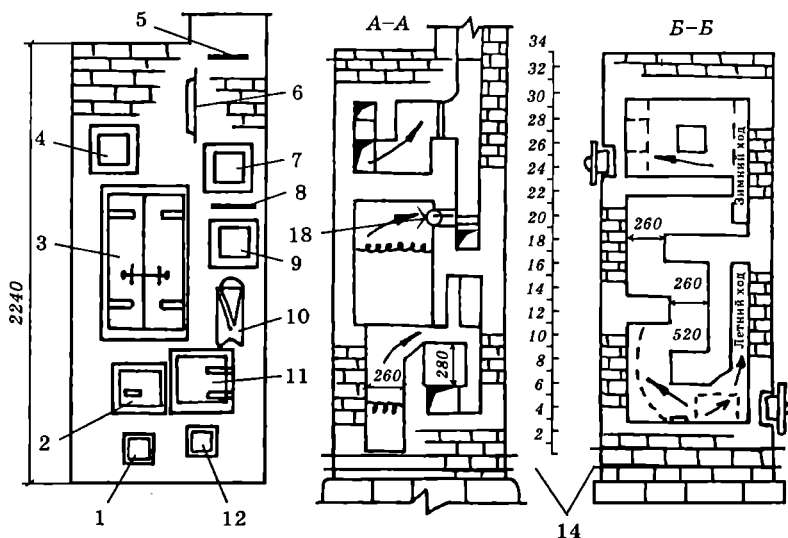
Отопительно-варочная печь конструкции И. Ф. Волкова: 1 — поддувало; 2 — топка; 3 — варочная камера; 4 — чистка; 5 — дымовая задвижка; 6 — задвижка, открываемая зимой; 7 — самоварник; 8 — задвижка, открываемая летом; 9 — чистка; 10 — водогрейная коробка; 11 — духовка; 12 — чистка; 13 — металлическая сетка в рамке; 14 — гидроизоляция; 15 — замкнутая внутренняя камера; 16 — канал для вентиляции камеры; 17 — чугунные плиты; 18 — вентиляционное отверстие с дверкой
